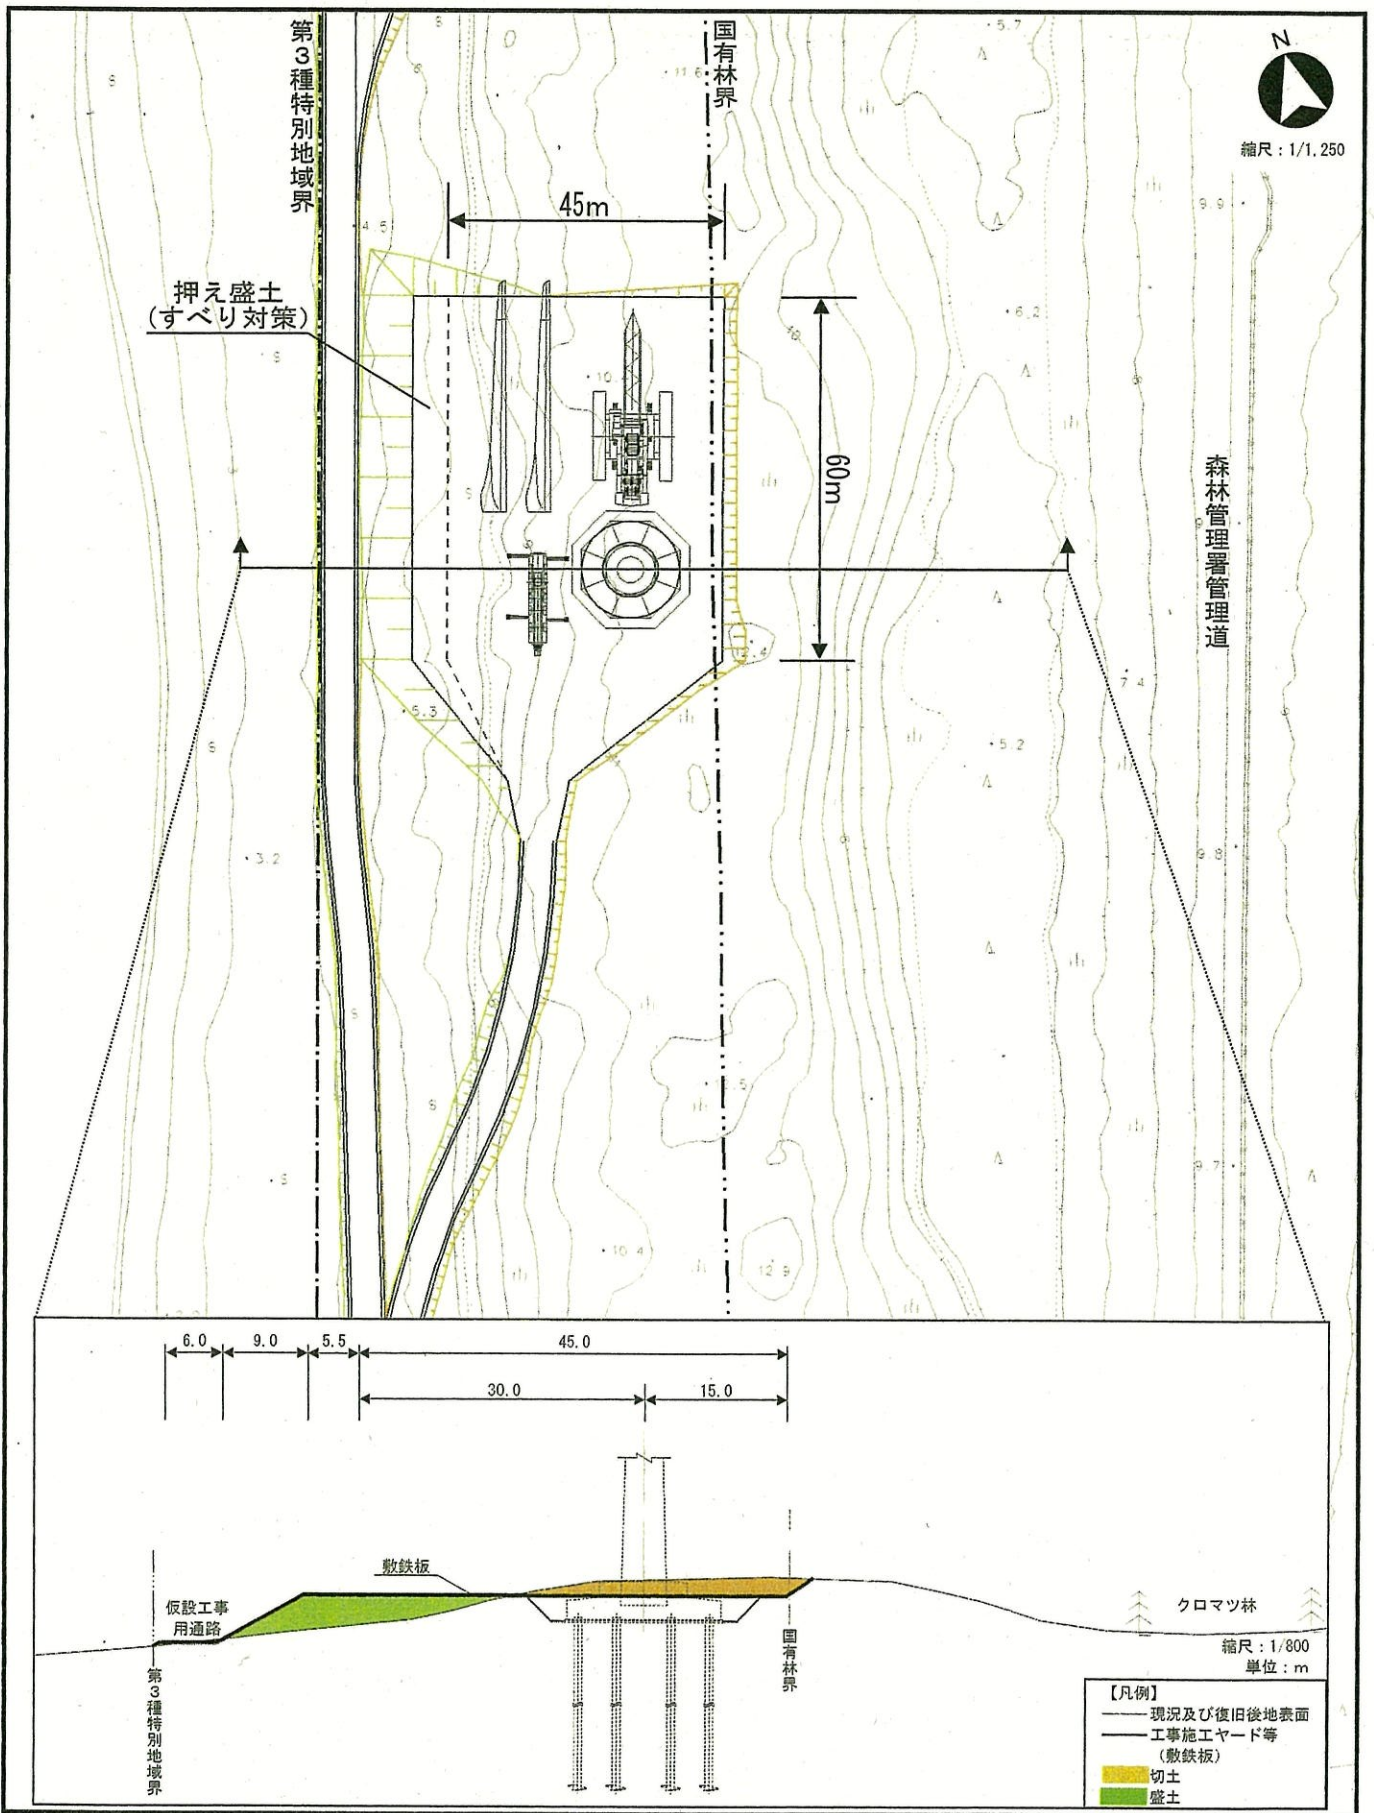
(4) 仮設ヤード等平面図 (設置時) (3号機)
